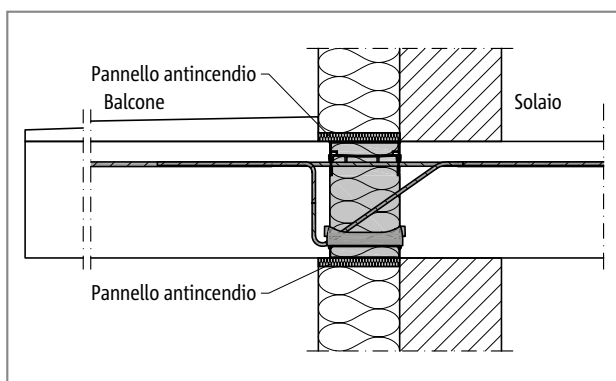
Schöck Isokorb® tipo KXT: configurazione REI30 nel sistema di isolamento a cappotto con strato isolante minerale
